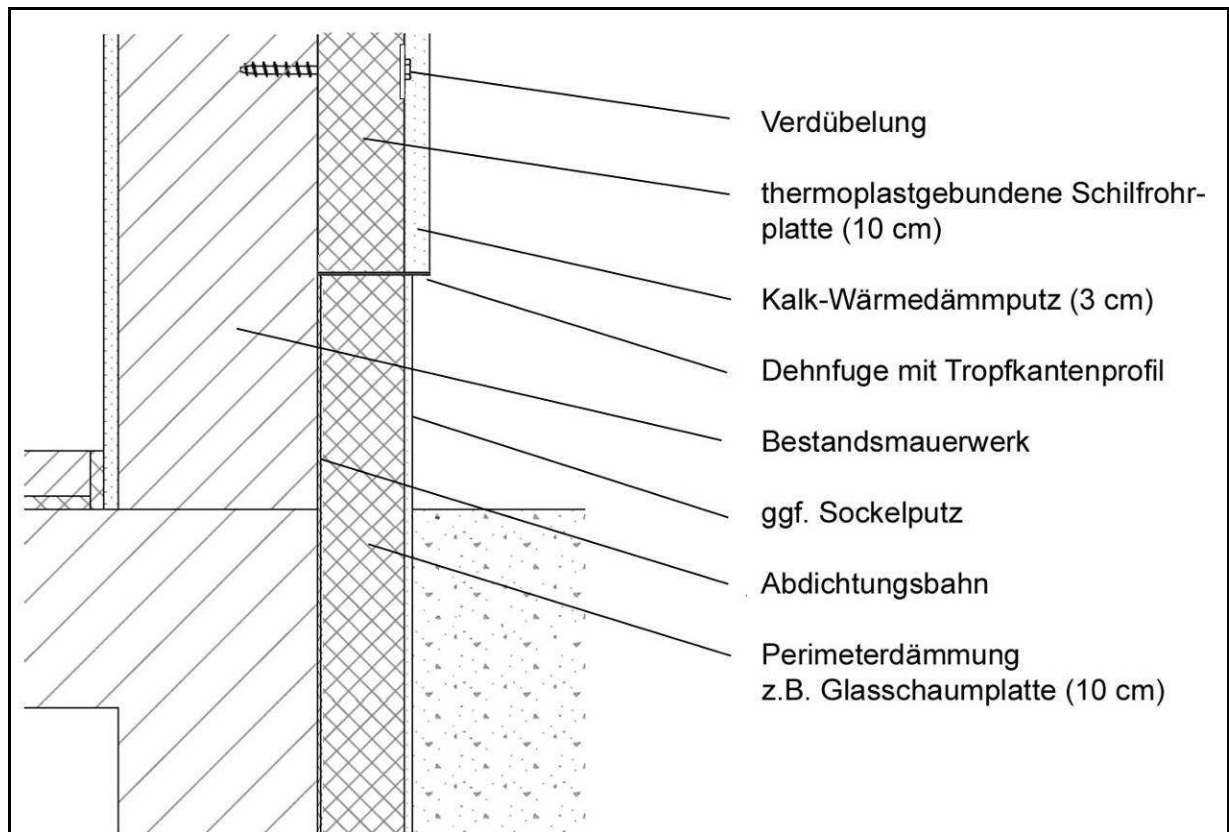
Konstruktionsdetail „Sockelzone Konstruktionstyp 1“
